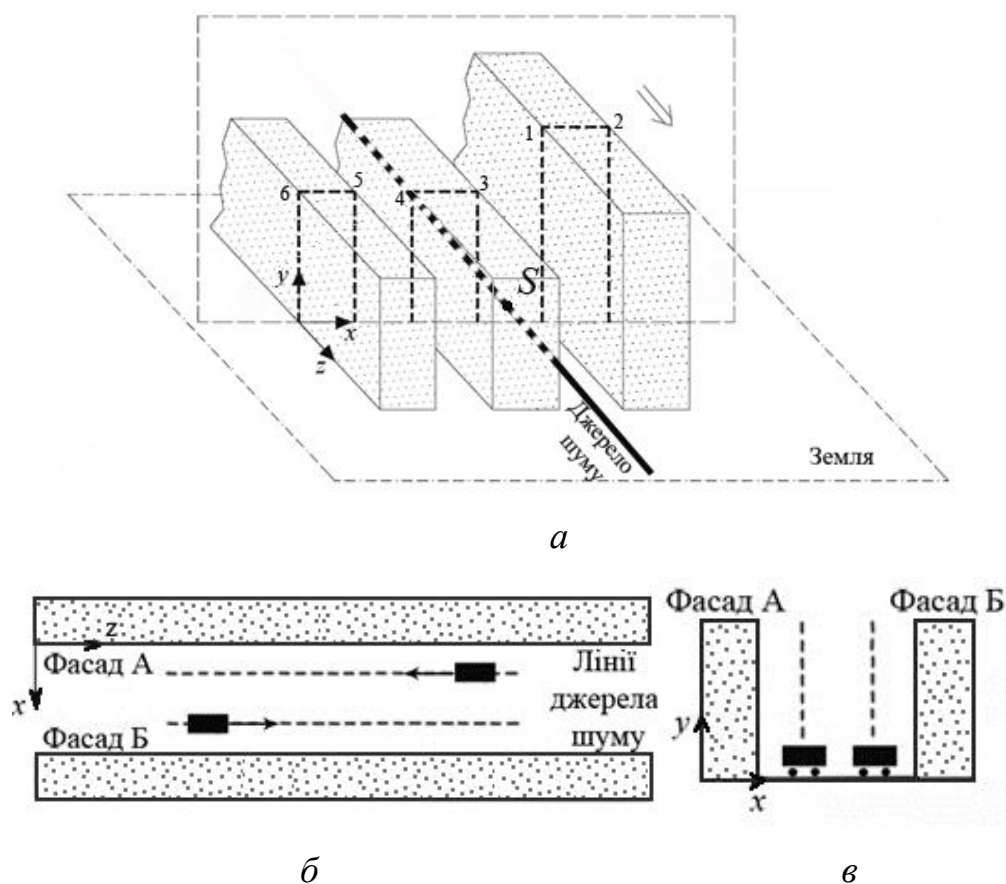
Схематичне зображення поздовжнього *б* та поперечного *в* перерізу вулиці *a
